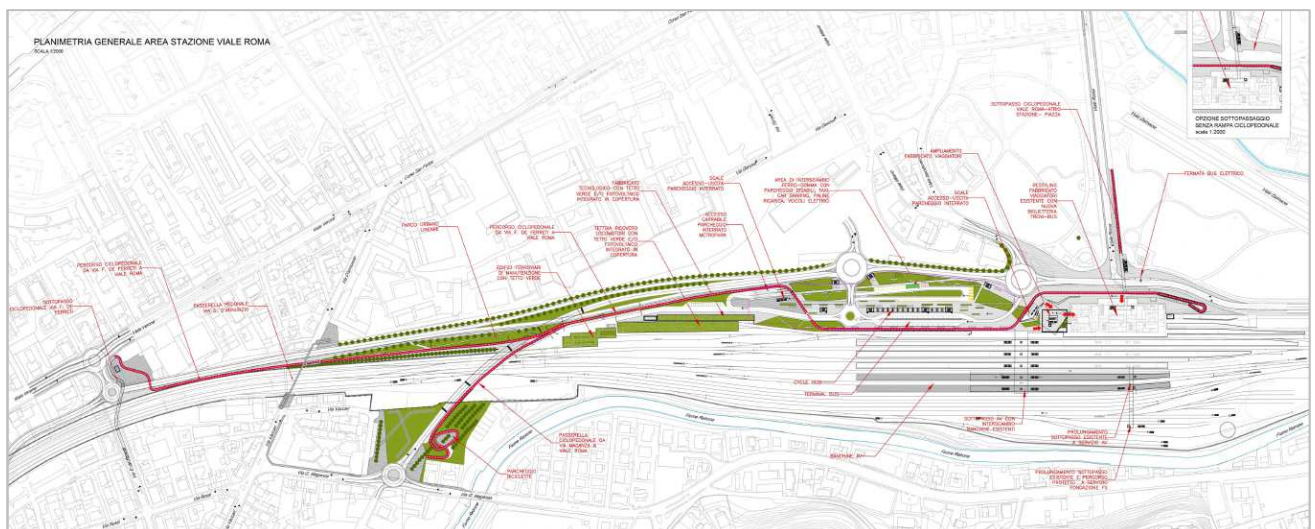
Stralcio planimetria generale Stazione Viale Roma
